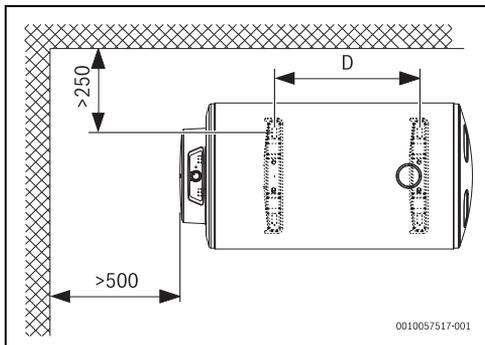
Dimensions en mm (montage mural, installation horizontale)
